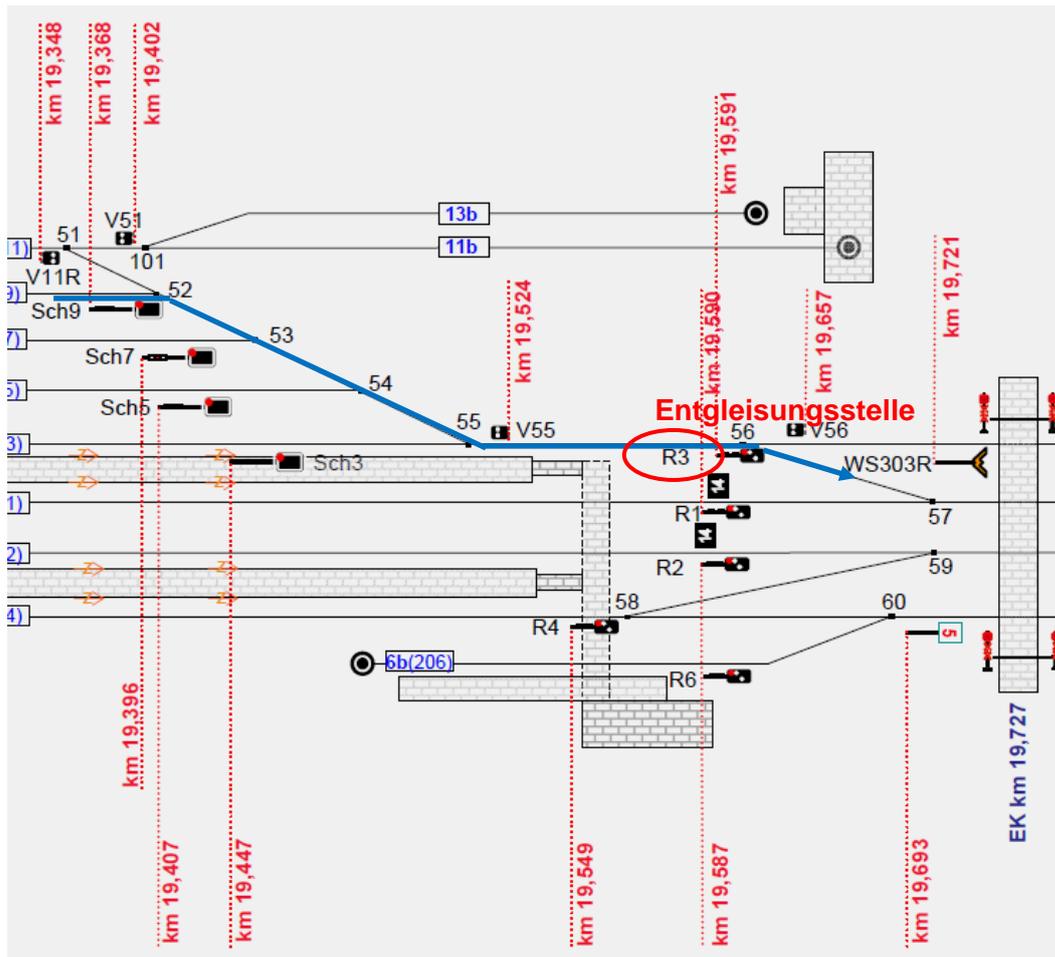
Lageplanskizze - Detail der Entgleisungsstelle - Quelle IM
